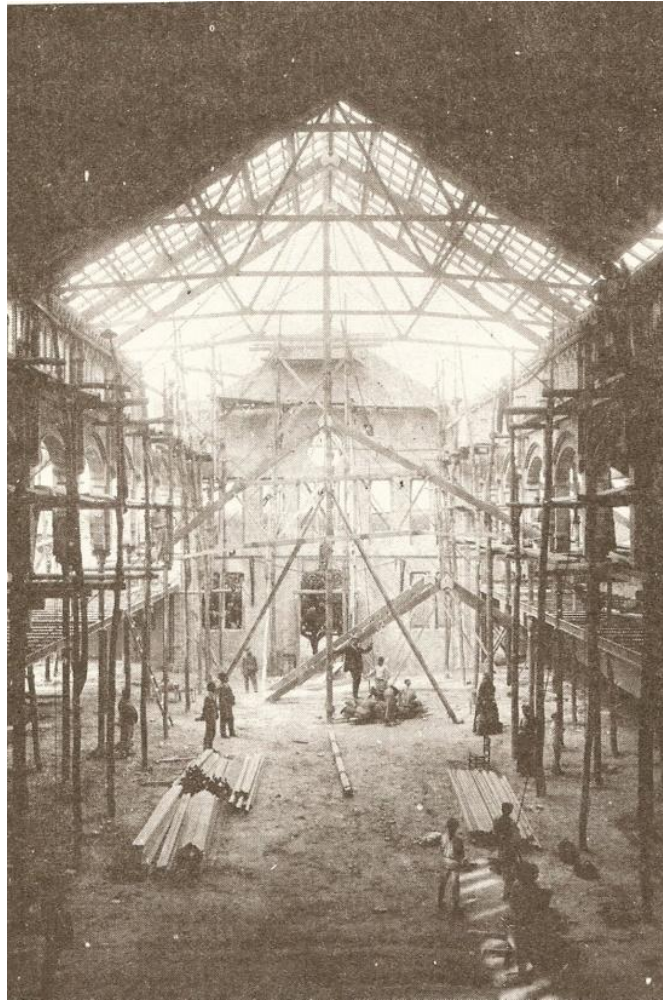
Vista del interior de la nave principal, en construcción.
